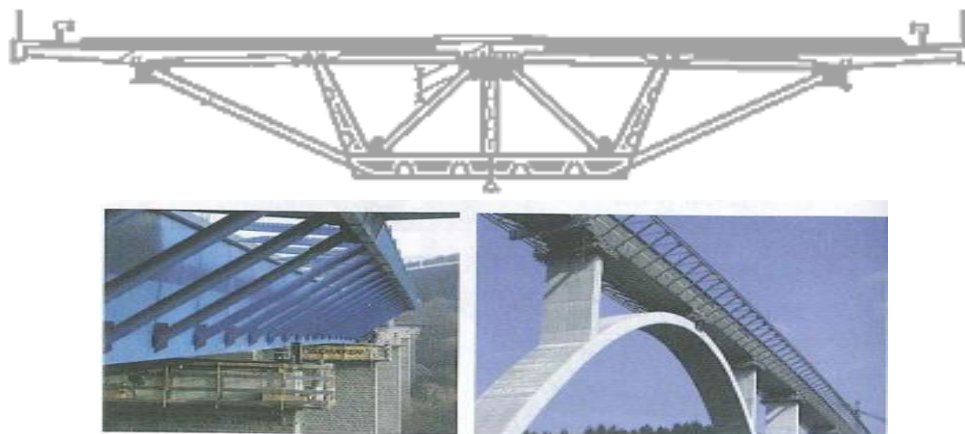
Сталезалізобетонна балка коробчастого перерізу зі збільшеними консолями залізобетонної плити
